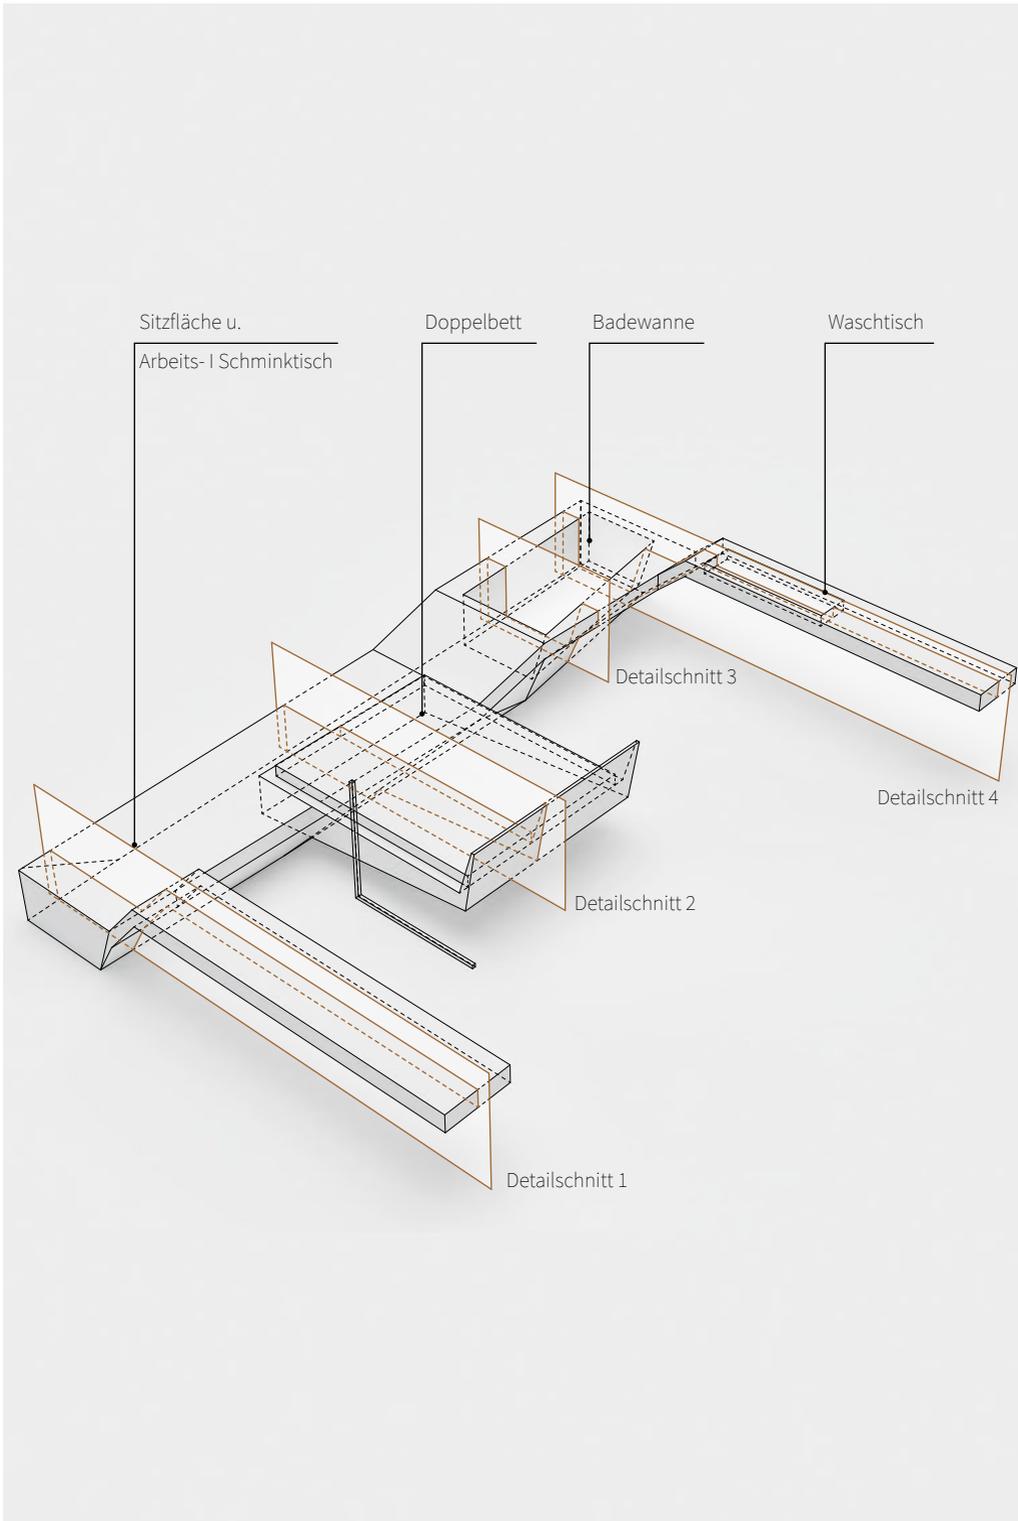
| Möblierung Hotelzimmer Junior - Suite Detailschnittflächen
